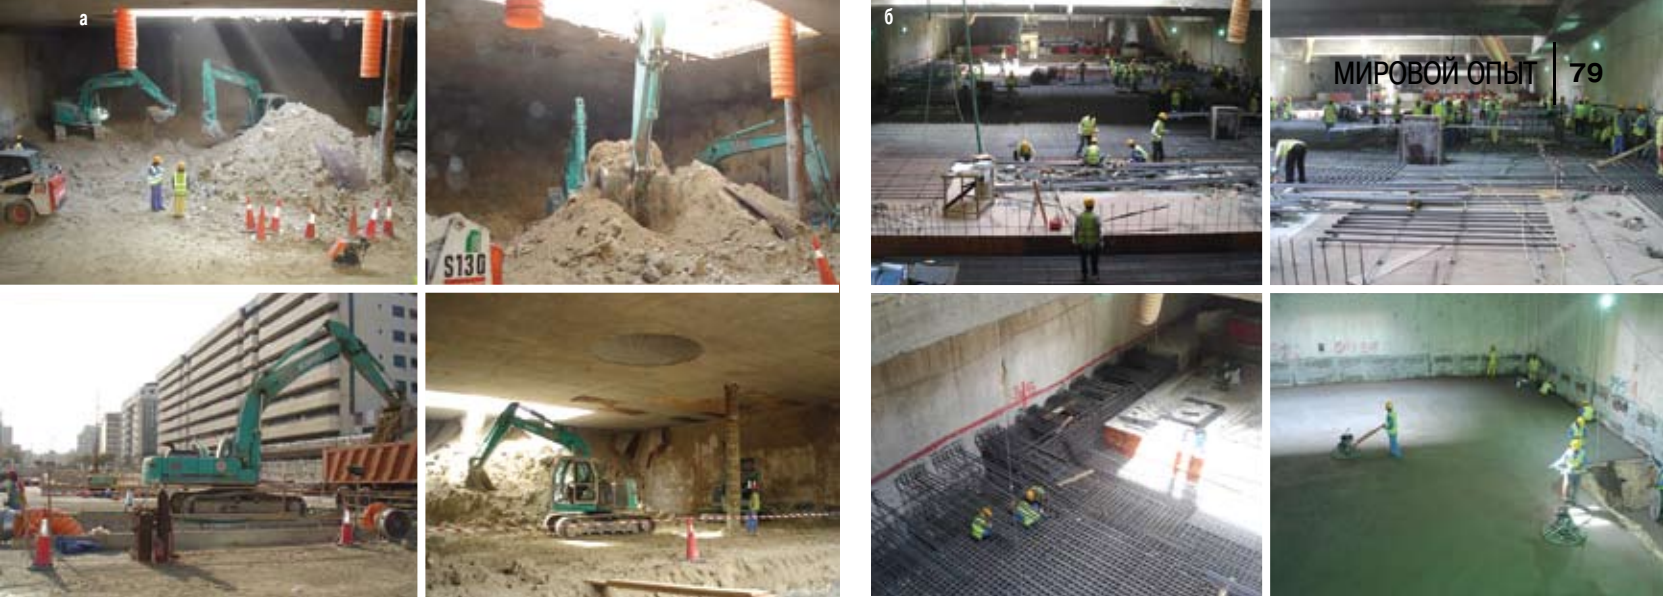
Строительство станционного тоннеля методом Top-Down: а – разработка породы; б – устройство фундаментной плиты
